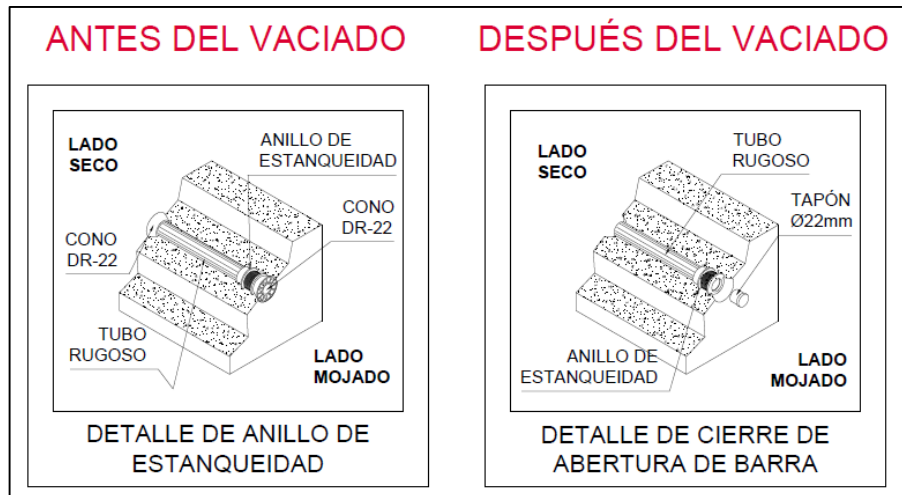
Detalle de tubería pasante en muro de cisternas.
